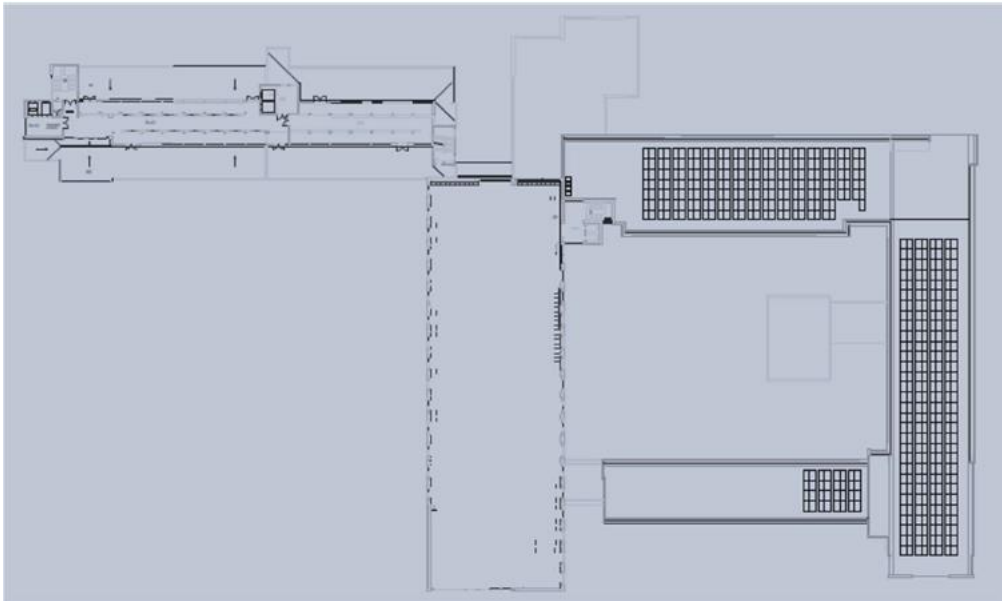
Planta da distribuição dos painéis [Projeto de execução]
